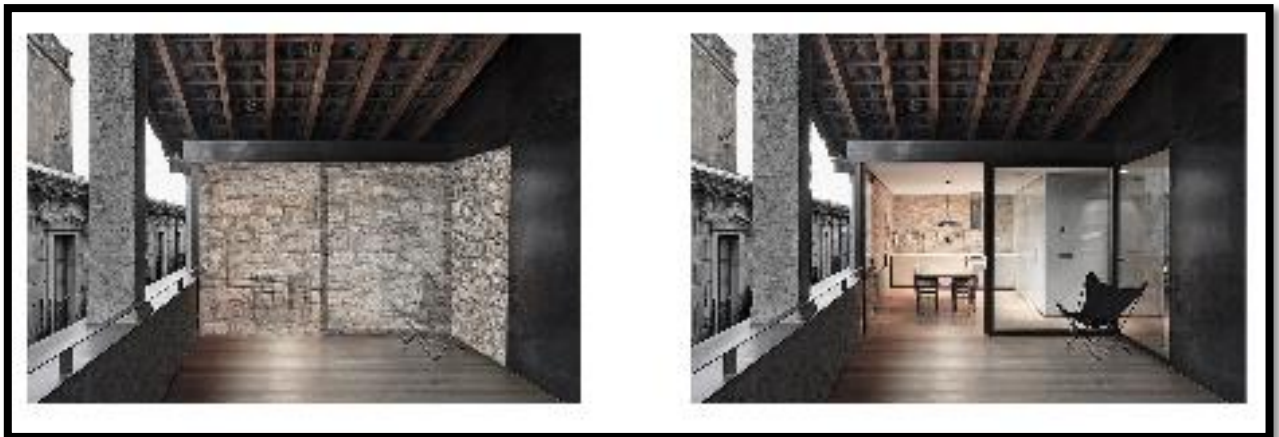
,77 y 78 Vista previa y posterior de los muros divisorios BJB | Fuente: Elaboración propia
